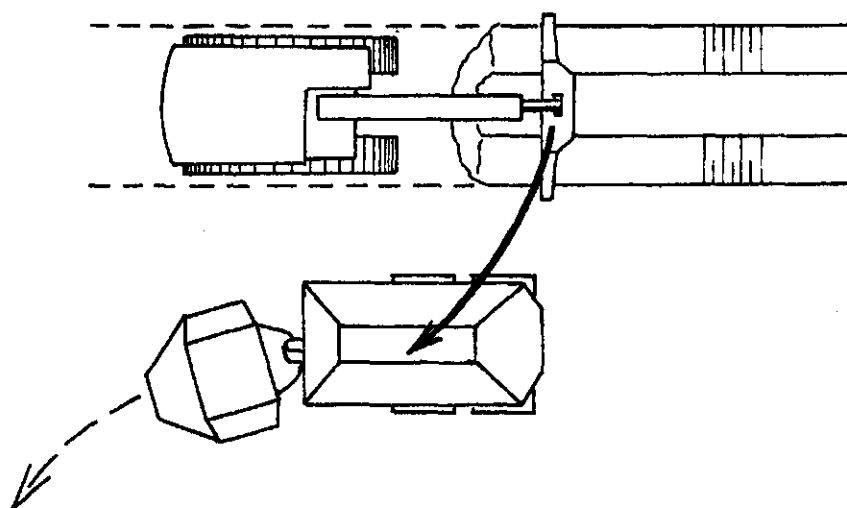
Opstelling dumper bij het laden tijdens graven van een leiding
